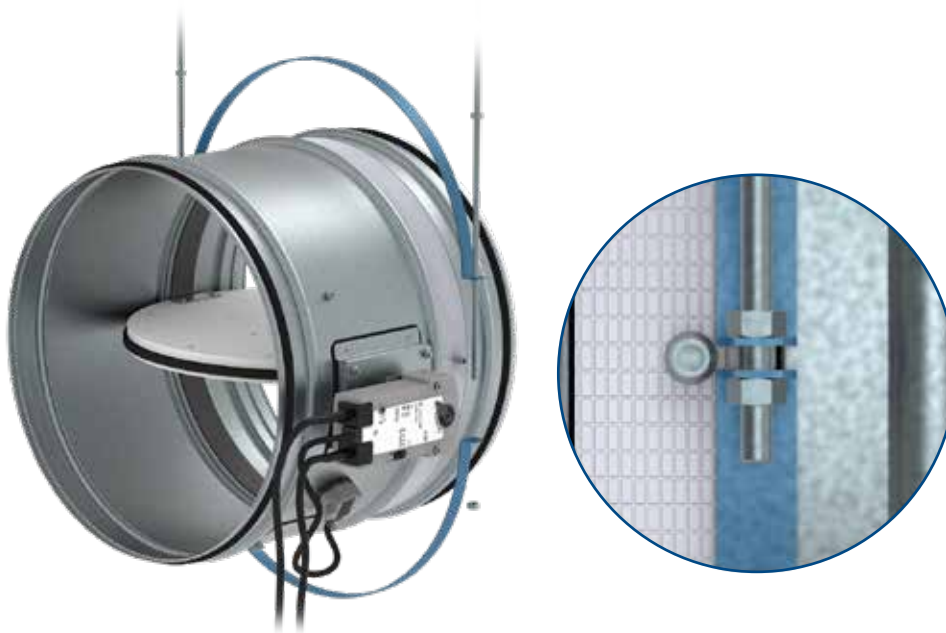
FDR-3G-brandklep voorbereiden voor montage, bij gebruik van 2 × M10 stang
